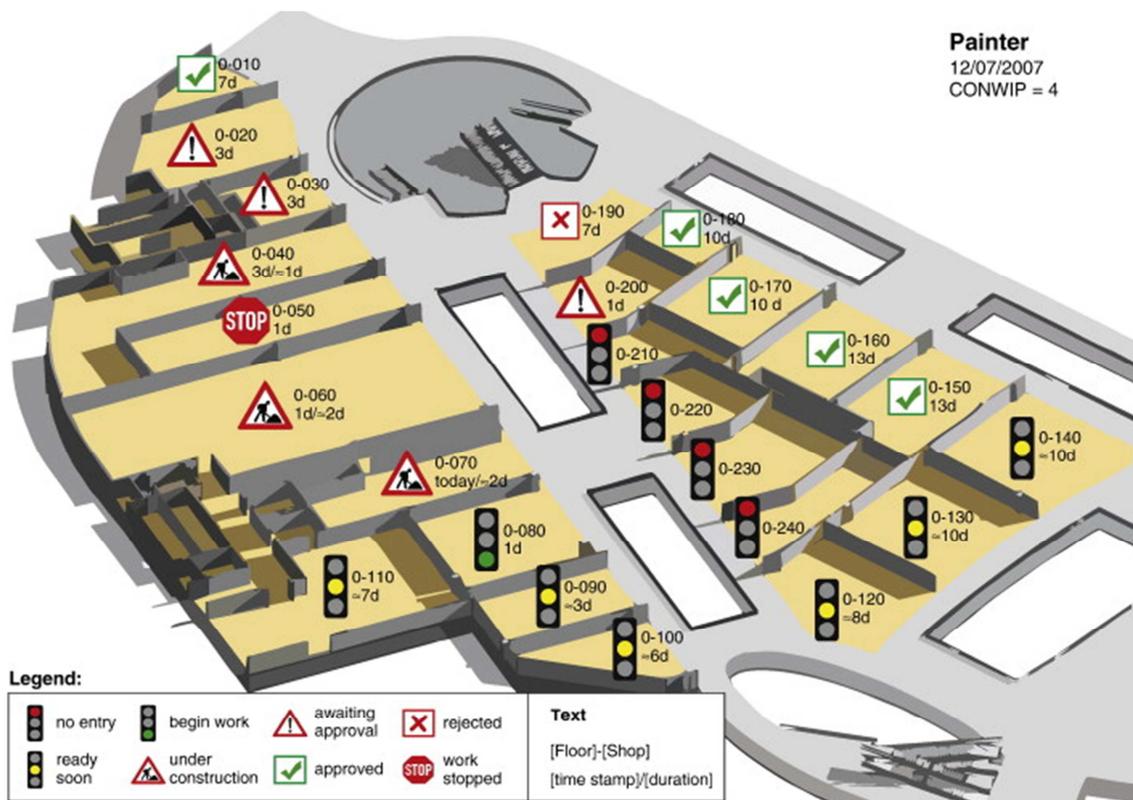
Ejemplo de sistema Andon aplicado a la construcción con BIM.
